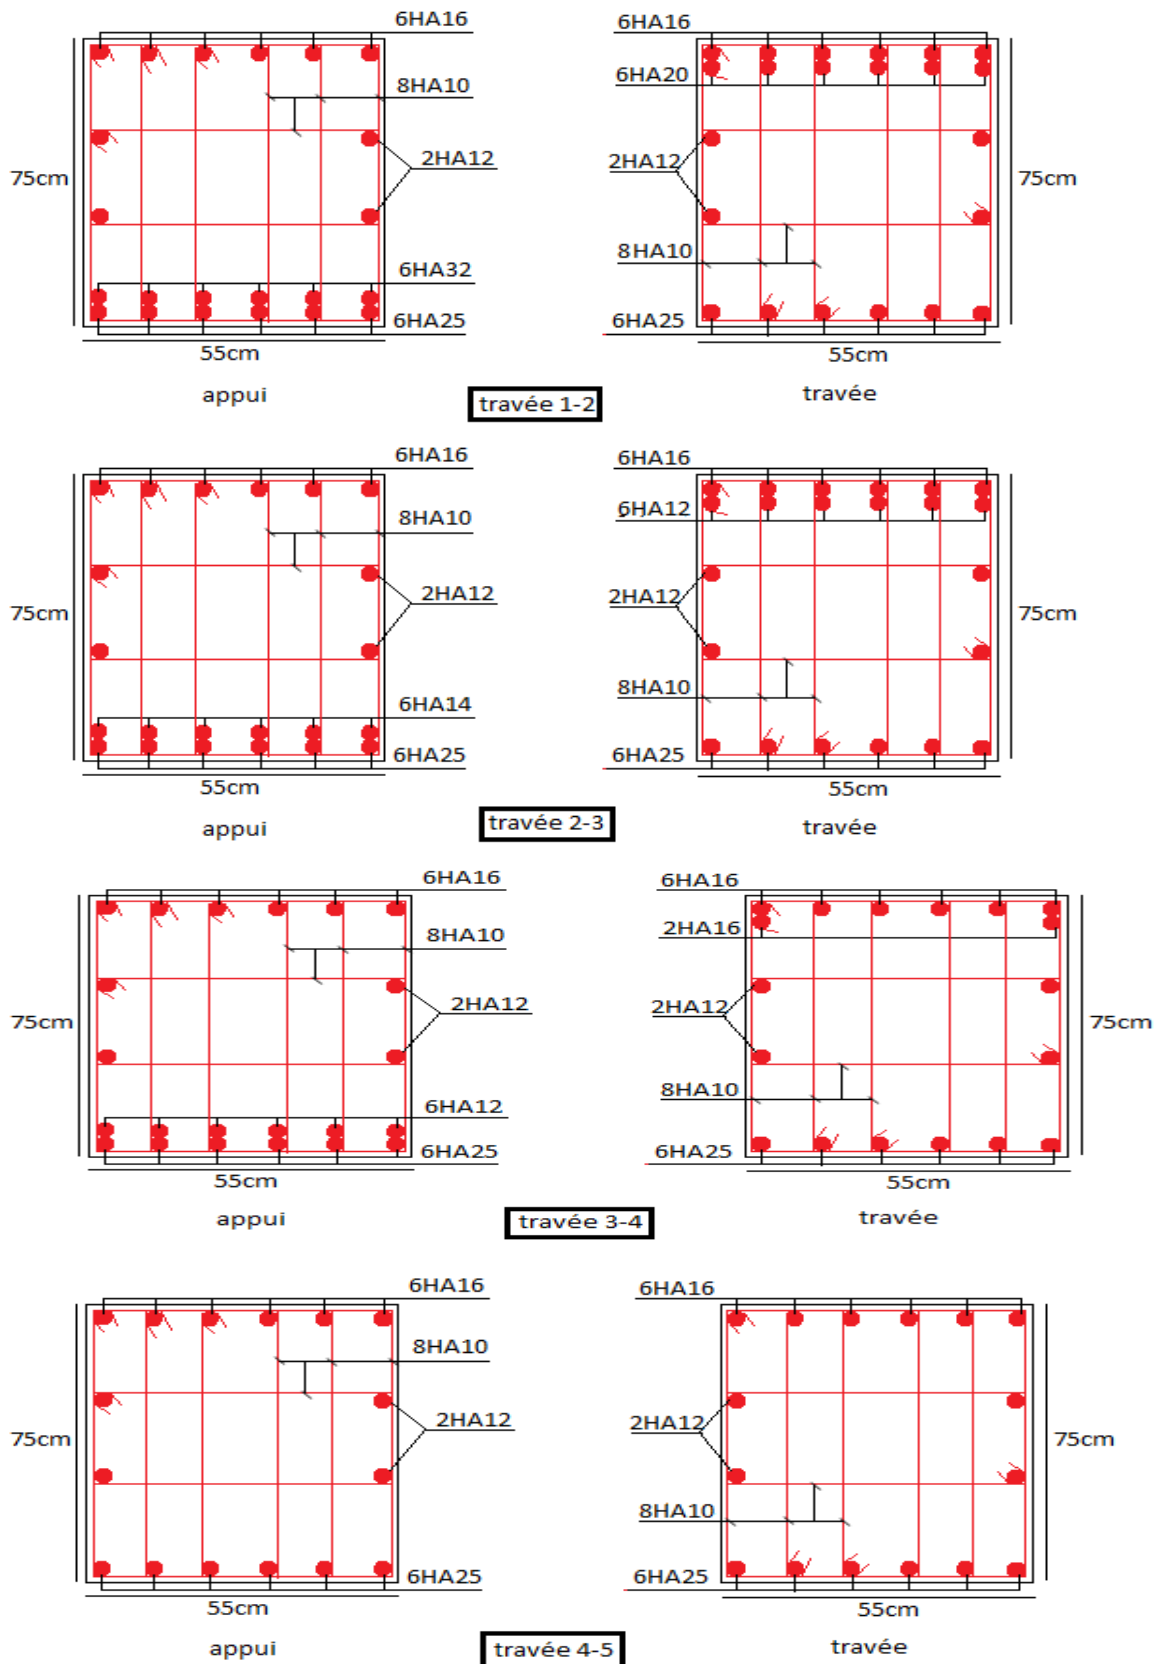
Schémas de ferrailages de poutre de rigidité (semelle sous poteaux , file G.)
